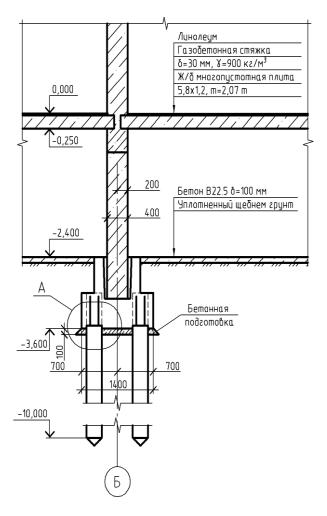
Пример оформления разреза отдельного свайного фундамента
